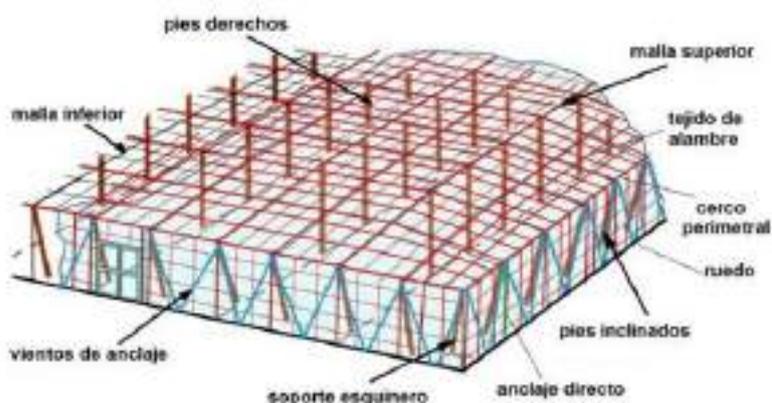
Invernadero elemental con estructura plana, denominado «parral plano»
